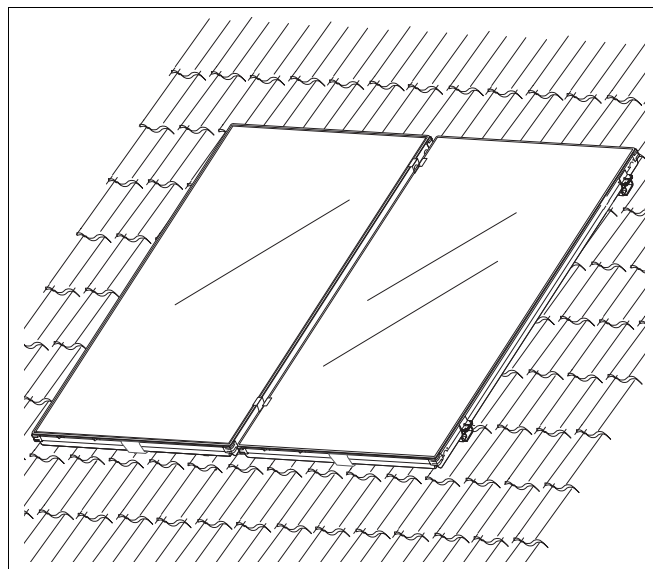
Vista general de dos colectores en montaje sobre tejado
